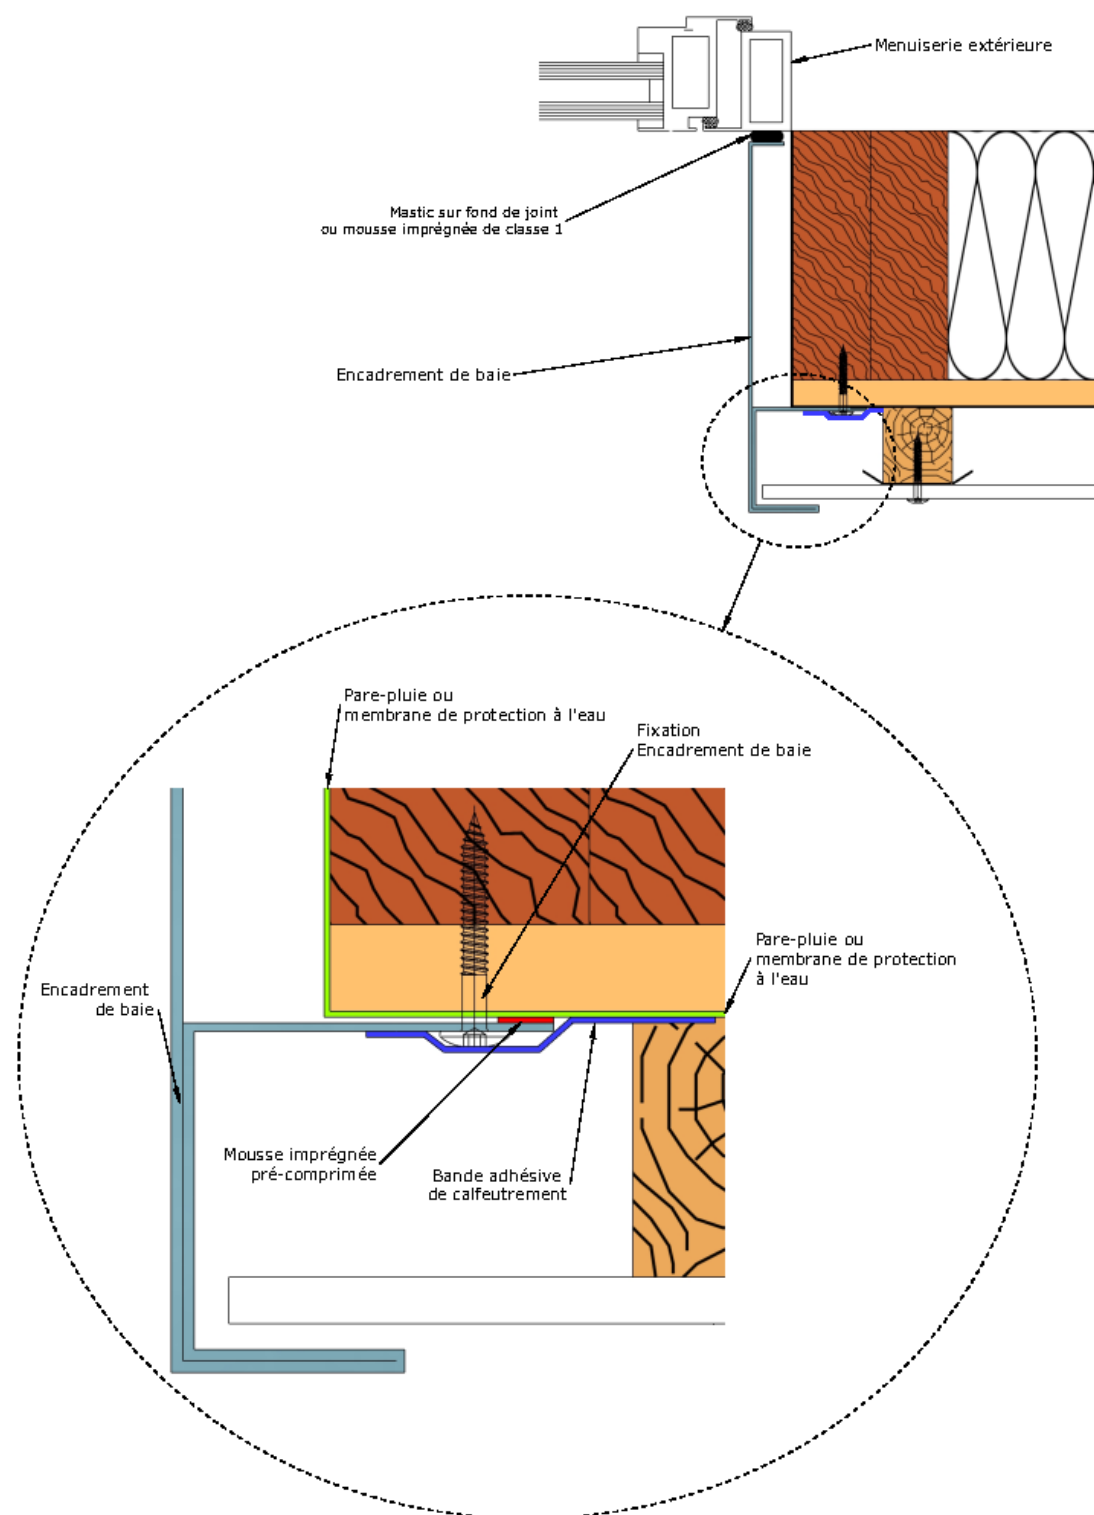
Liaison pare-pluie ou membrane de protection à l'eau avec encadrement de baie monobloc soudé 4 cotés acier 15/10e, Ee2, coupe horizontale tableau
